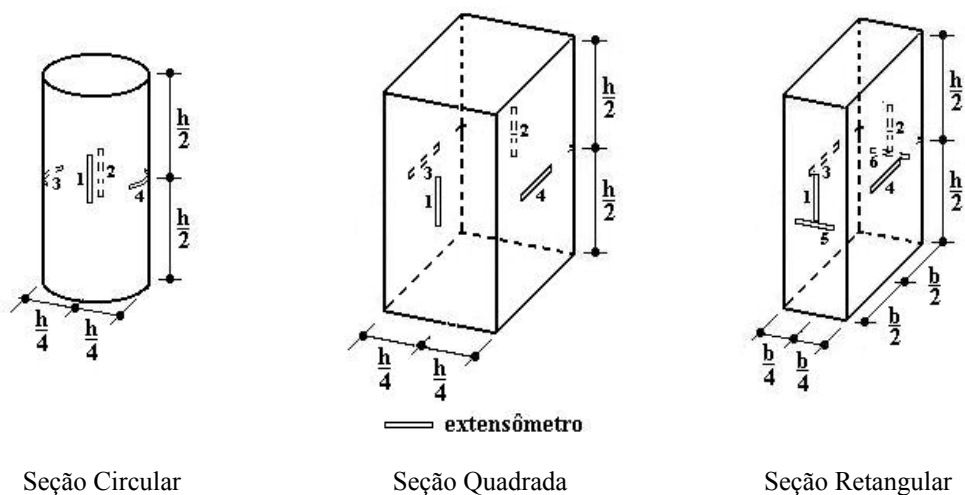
Instrumentação Externa dos Pilaretes Ensaçados
